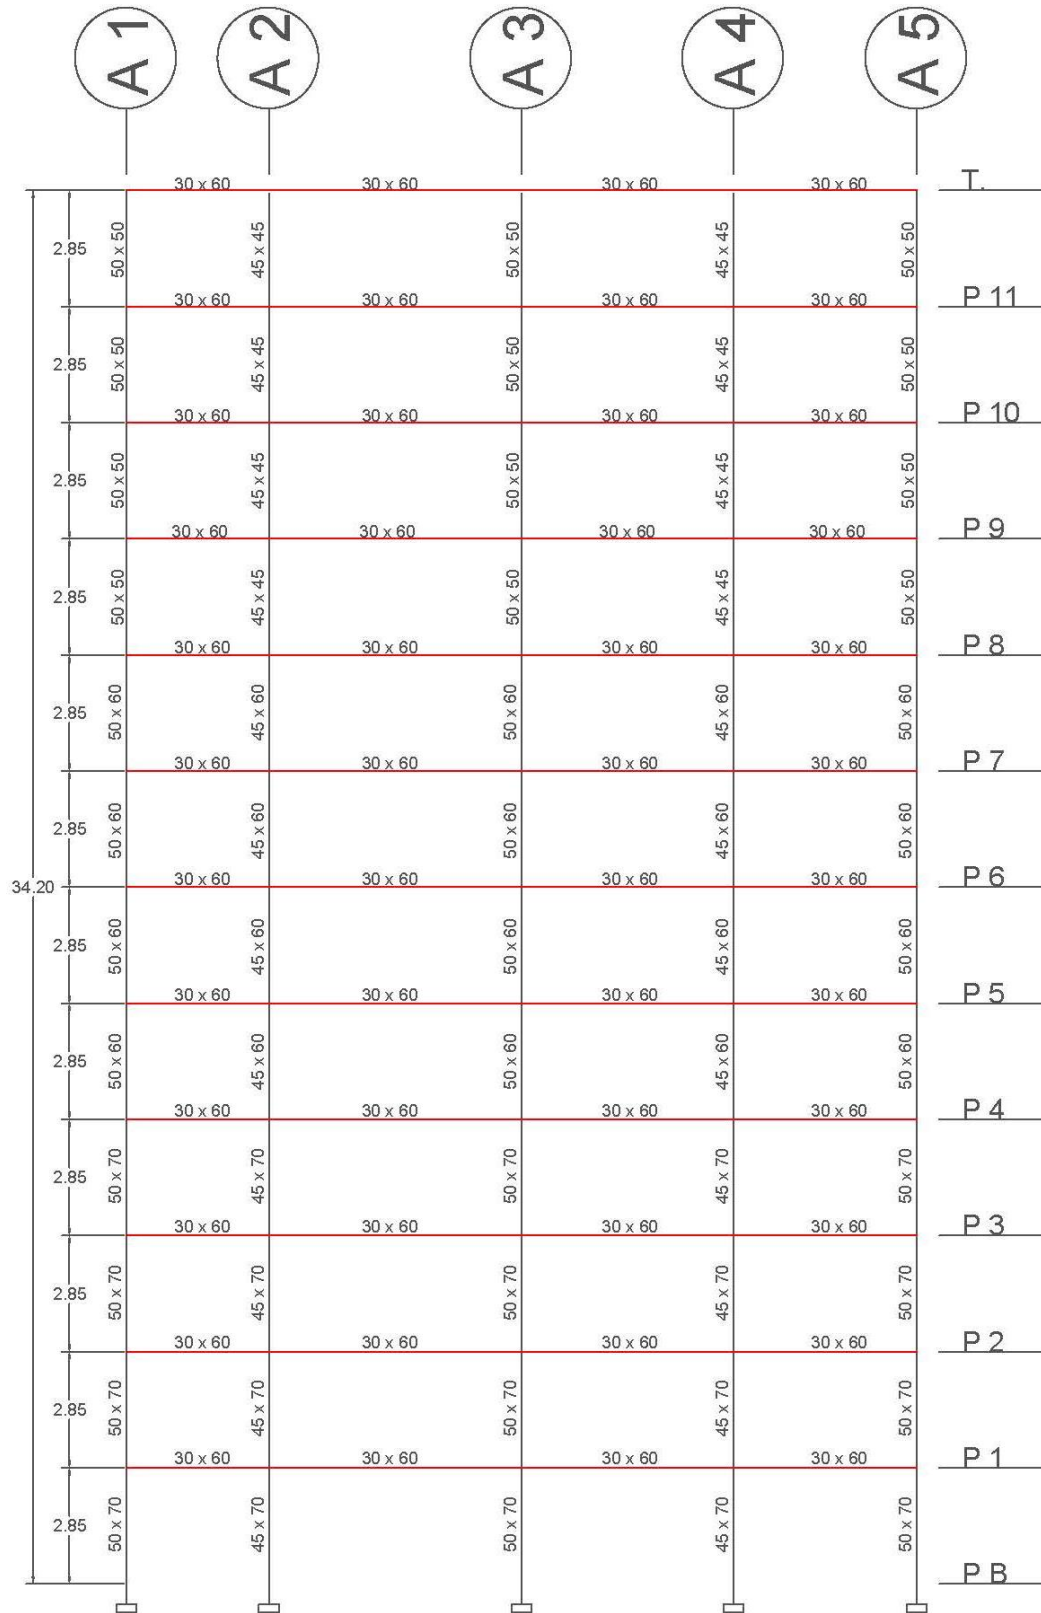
ELEVACIÓN DE PÓRTICO A Y F
